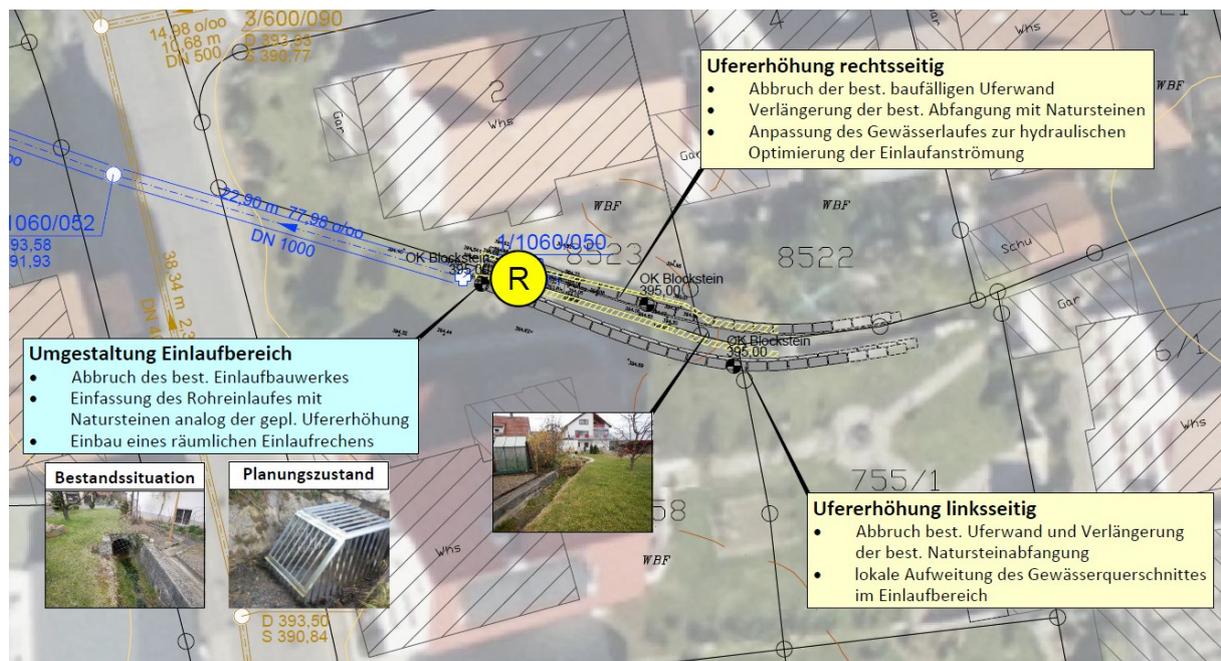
Ausschnitt Lageplan Maßnahmen zur Einlaufoptimierung am Krebsgraben
